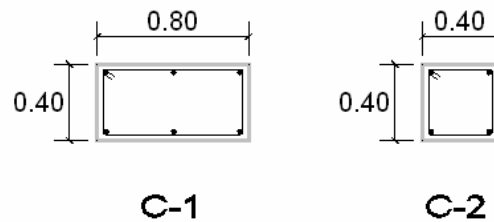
Detalle de columnas de concreto armado (Edificio Gran Unidad Escolar)
